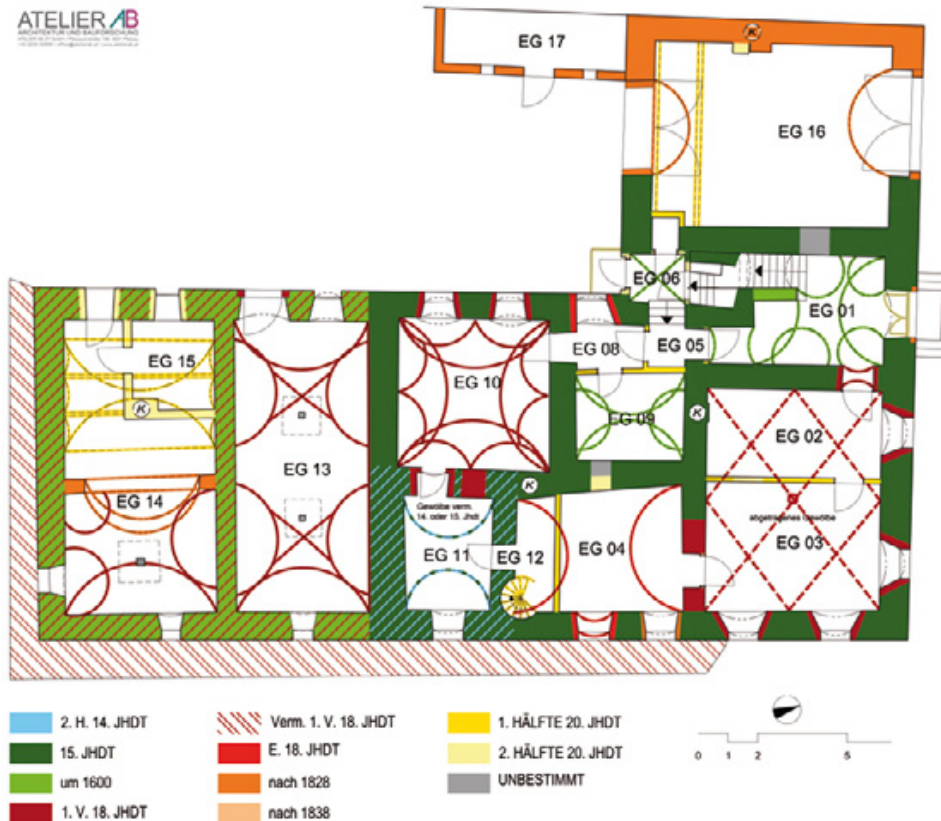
Unterweissenbach, ehemaliges Bezirksgericht. Baualterplan des Erdgeschoßes.
